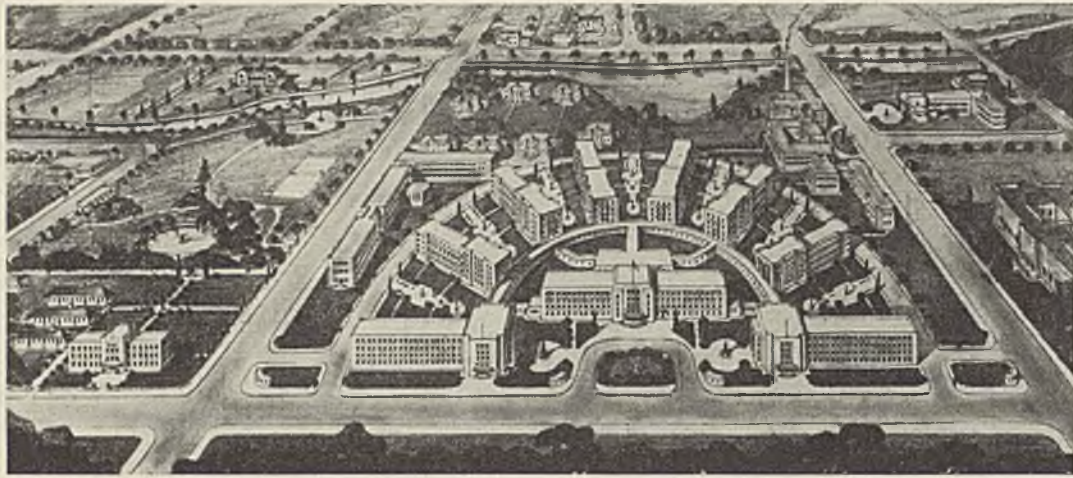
Das Krankenhaus mit den geplanten Anbauten.
